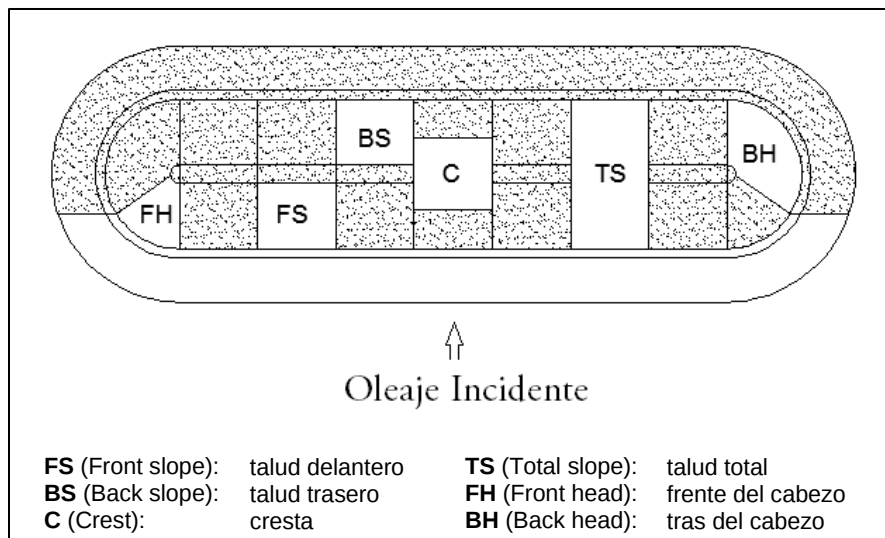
Vista en planta de un rompeolas tipo y sus divisiones.
